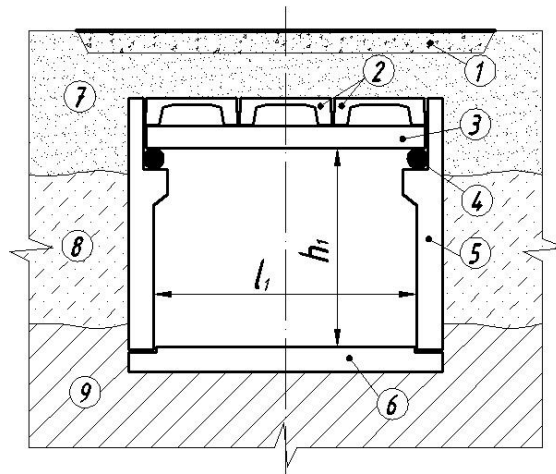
Общий вид подземного сооружения с шарнирно-опертой балкой и автодорога: 1 – асфальтобетонное покрытие дороги; 2 – ребристые плиты перекрытия; 3 – железобетонная балка; 4 – шарнирные катки; 5 – стенки сооружения; 6 – днище сооружения; 7 – грунт из пылеватых песков; 8 – грунт из супеси; 9 – грунт из твердой глины
